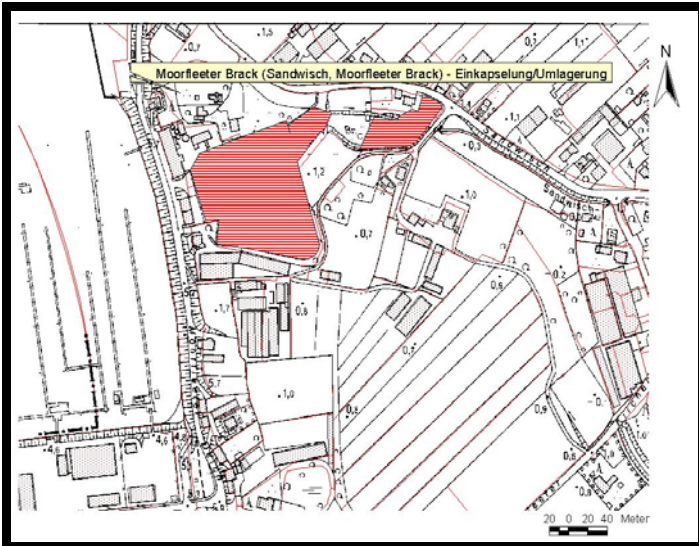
/2 Lageplan 1. Teilbaumaßnahme / Einkapselung/Umlagerung
